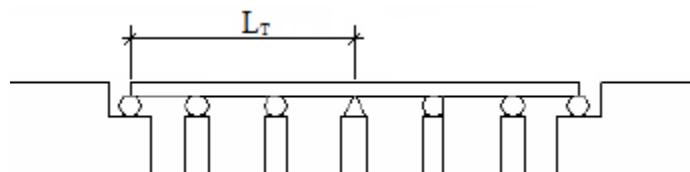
Longitud de dilatación en estructuras continuas con apoyo fijo intermedio
